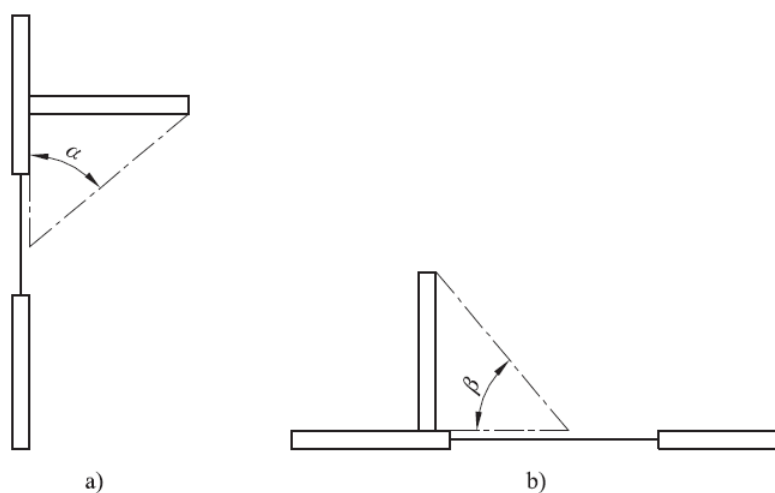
Aggetto orizzontale: a) sezione verticale, b) sezione orizzontale
